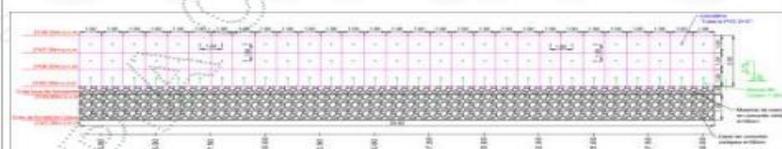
Tipo de la Obra: Muro en gaviones
